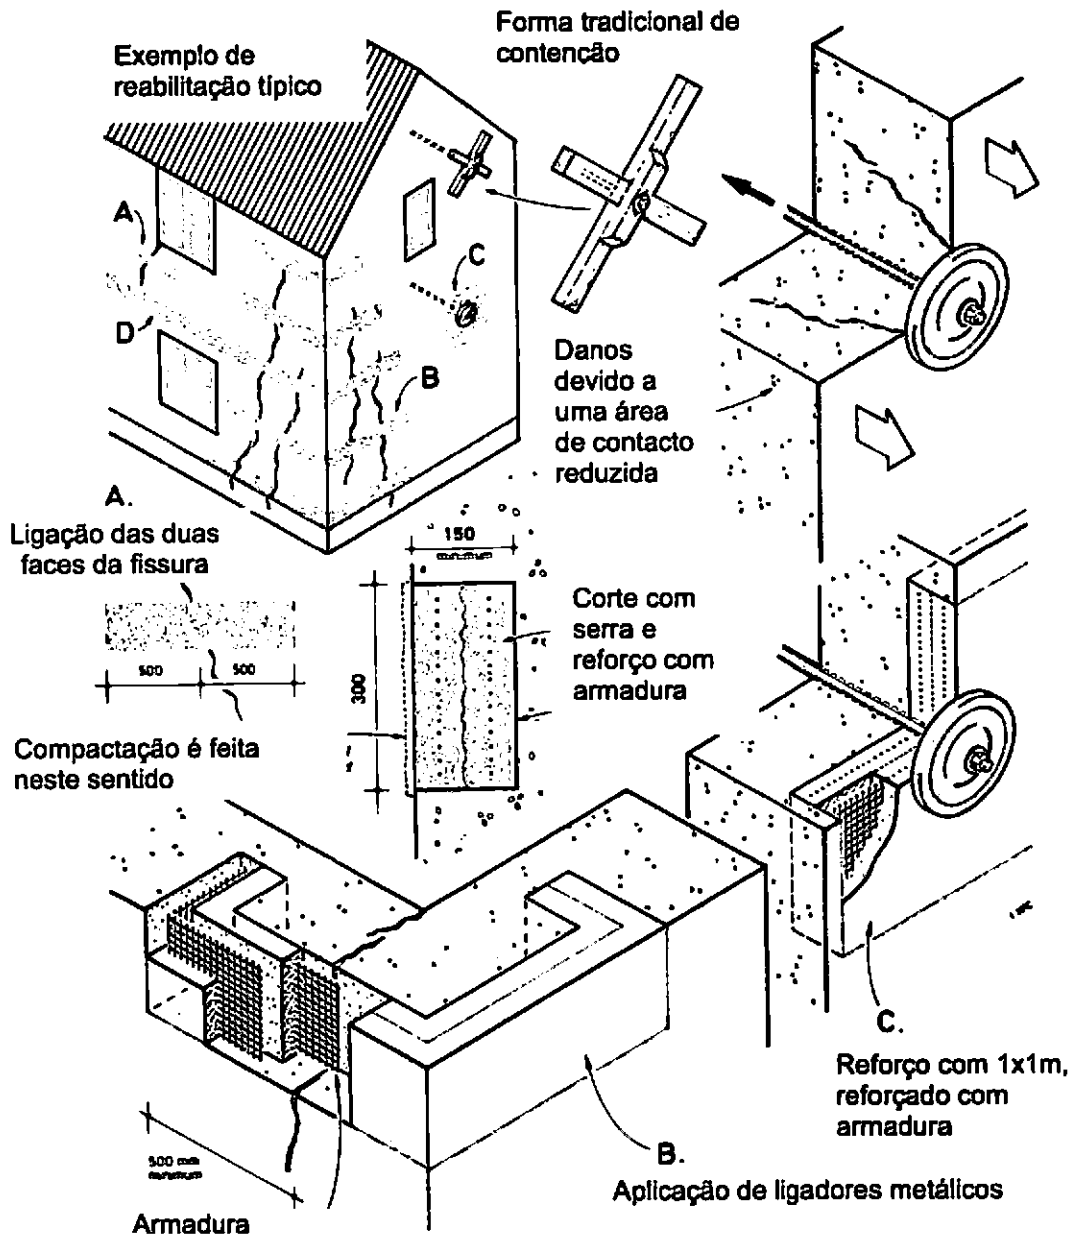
Esquemática da reparação de fissuração em cunhais e pontos de apoio de esticadores.
